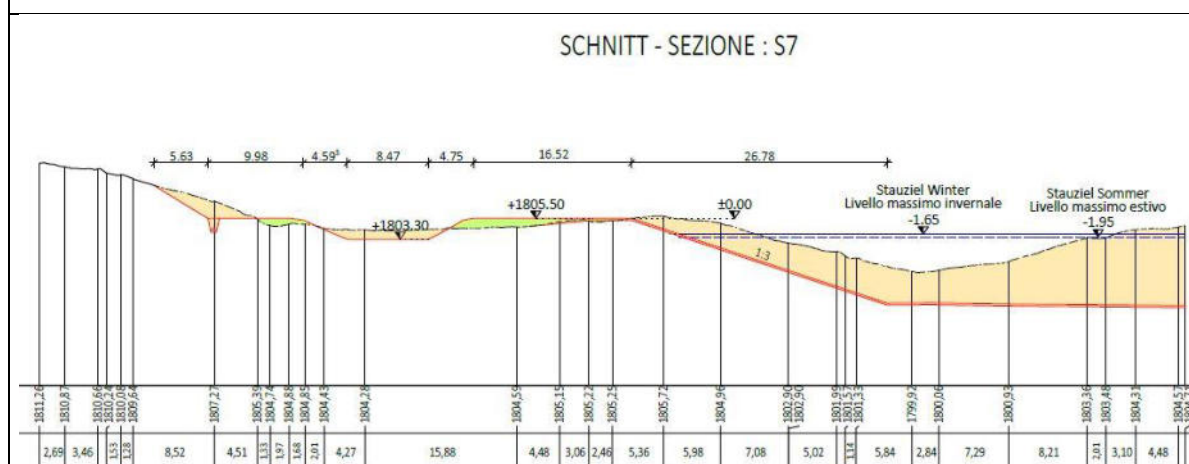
Auszug aus dem Projekt: Schnitt S7 / Stralcio da progetto: sezione S7
